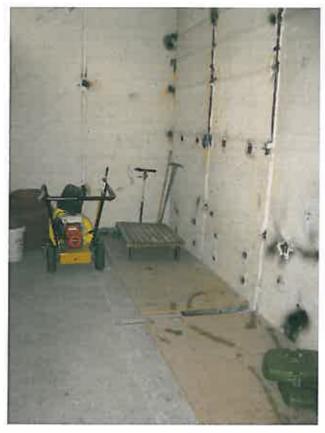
Blick in das Gebäude (rechts unten: abgedeckte Leitungskanalvertiefungen)
